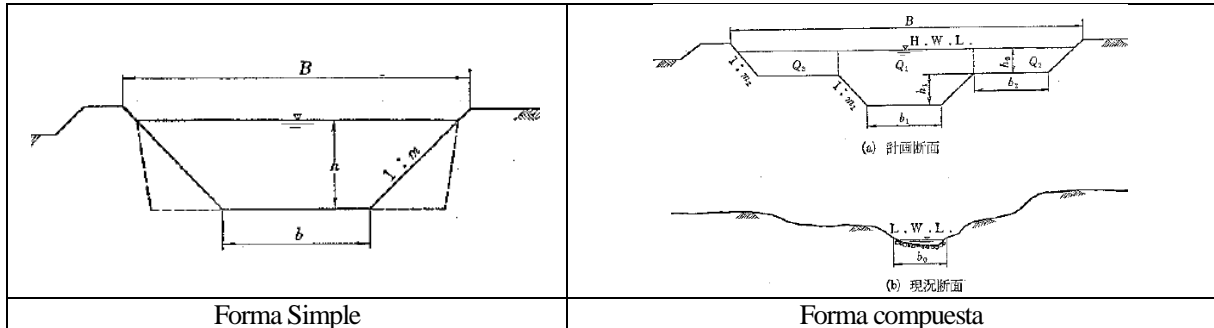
Tipos de Sección Transversal de Canal de Río
